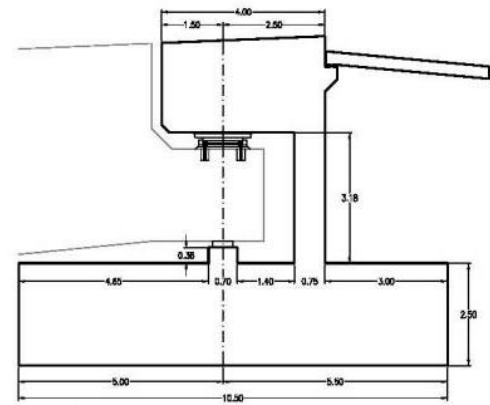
Estribo 5 de empotramiento con apoyo invertido
